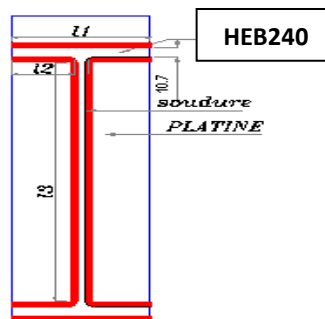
Les dispositions constructives de la soudure
